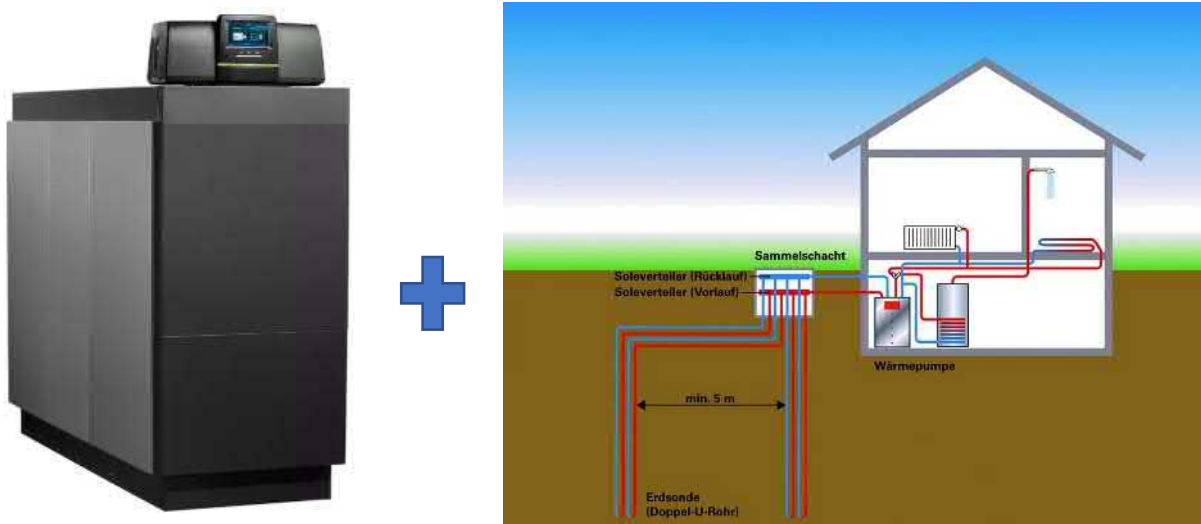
Sole-Wasser-Wärmepumpe + Gaskessel
